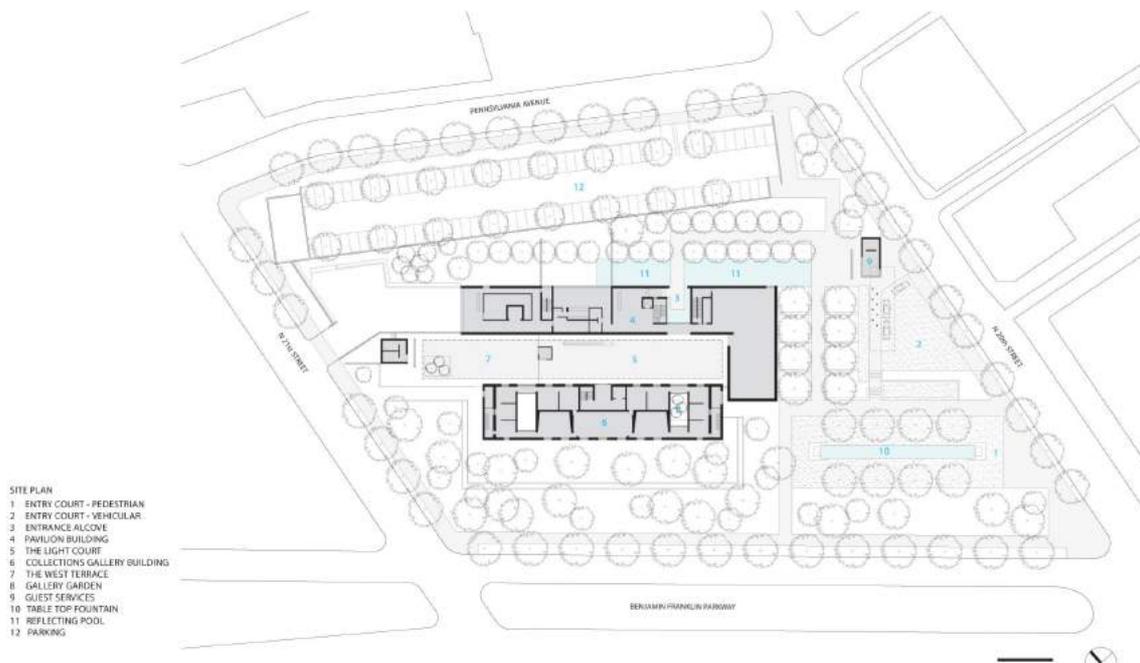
Planta Baixa Situação. Fonte: www.archdaily.com
